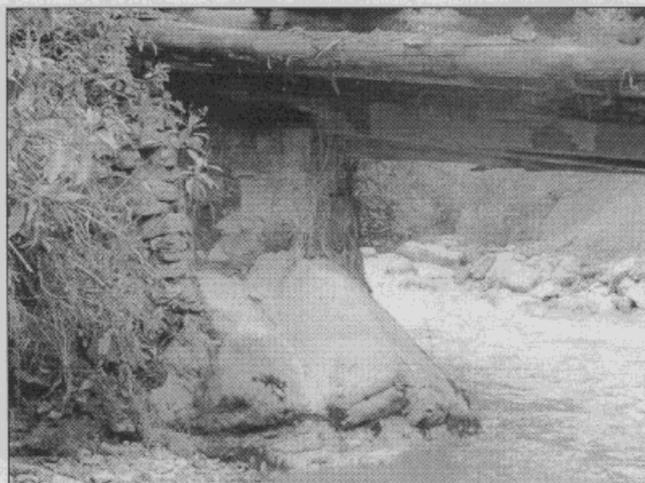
Se observa el agrietamiento de una de las vigas superiores.
